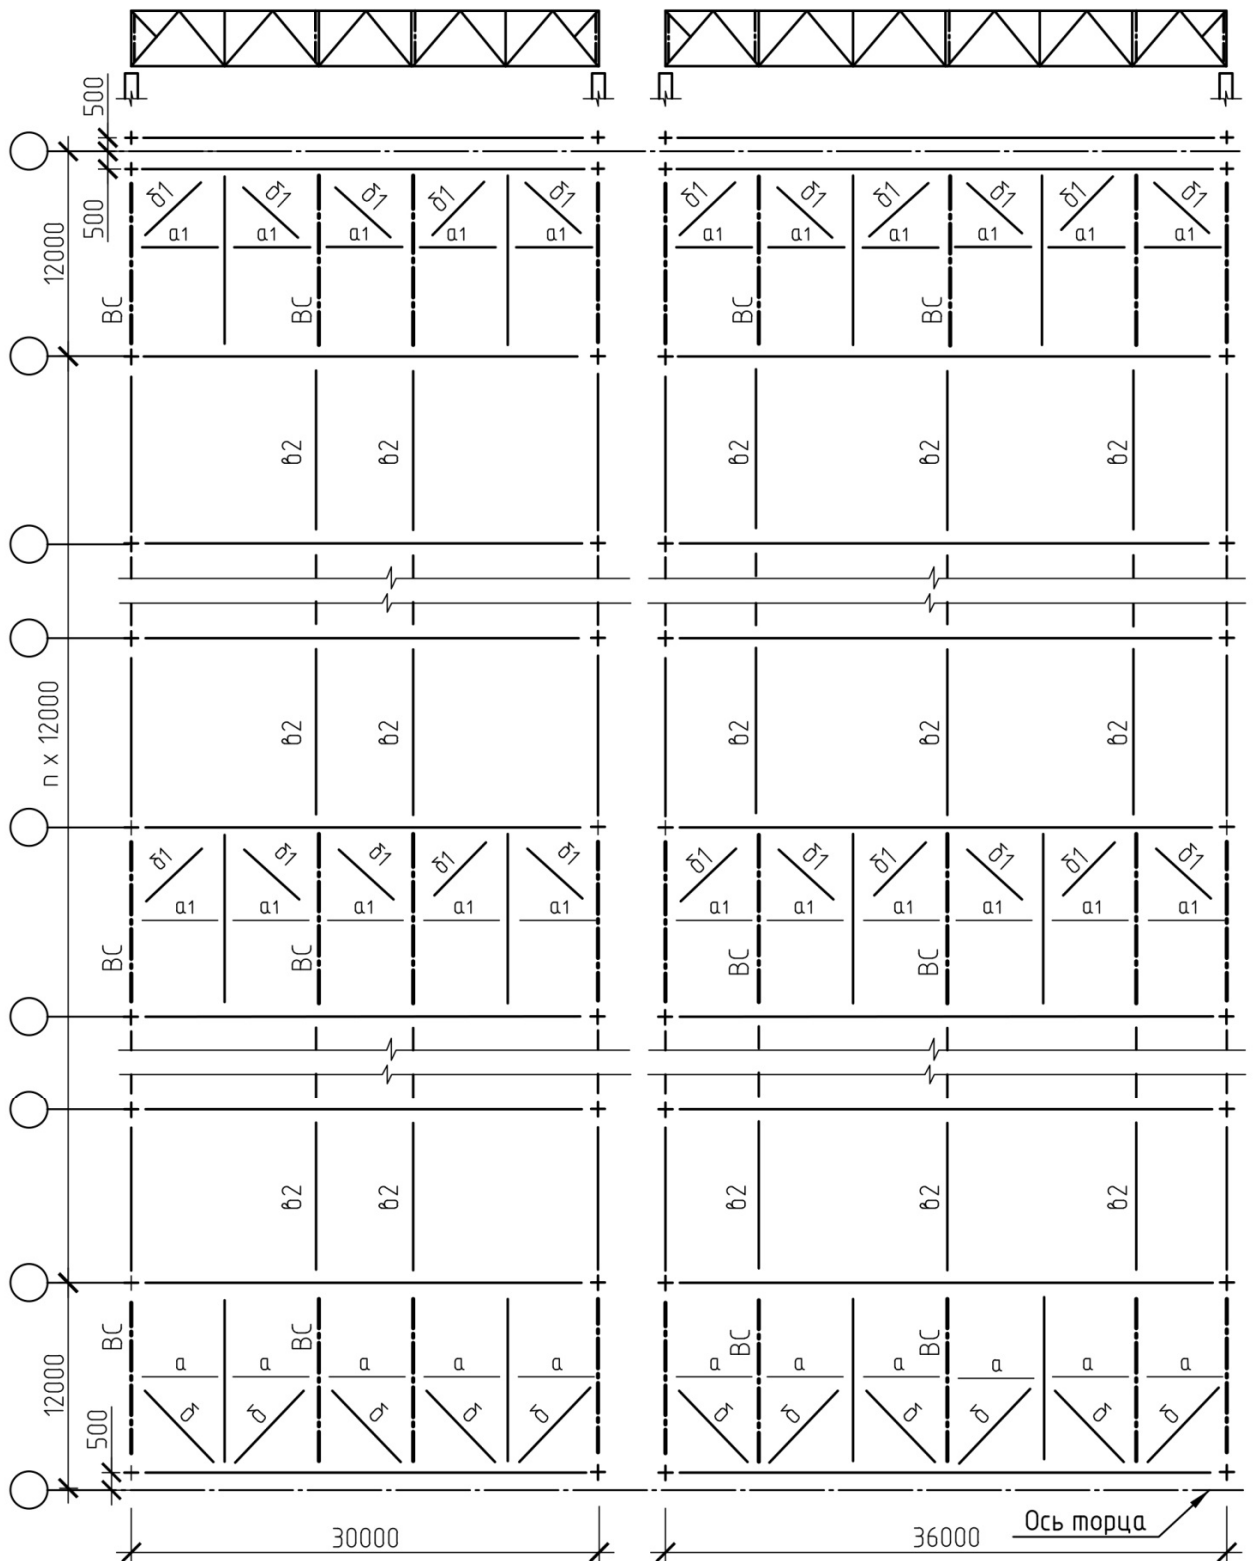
Схемы расположения связей II типа по нижним поясам стропильных ферм, шаг ферм 12 м, пролеты 30 и 36 метров
